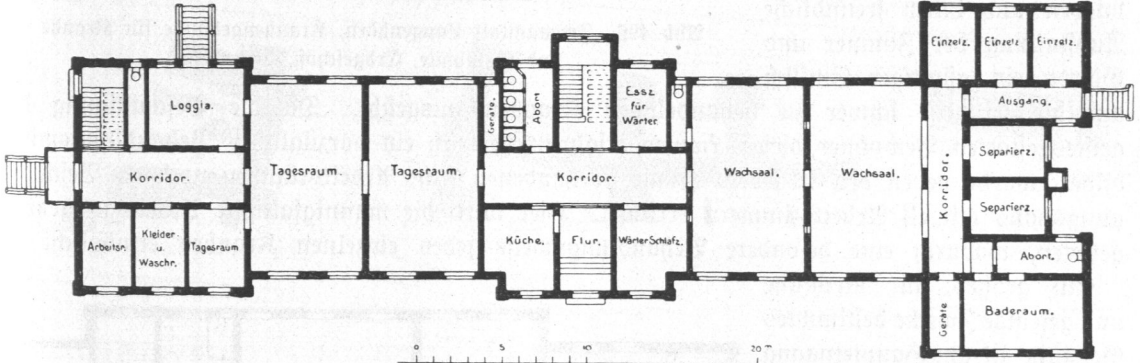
Irrenanstalt Langenhorn, Überwachungshaus für 50 Männer und 8 Wärter, Erdgeschöß, Grundriß.
